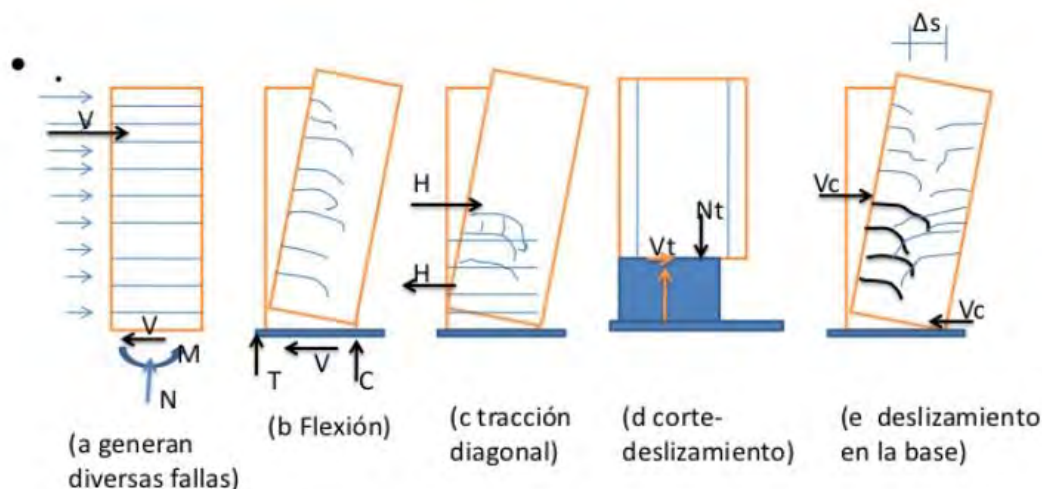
Tipos de falla en muros: Muros de corte o placas. (1994)
